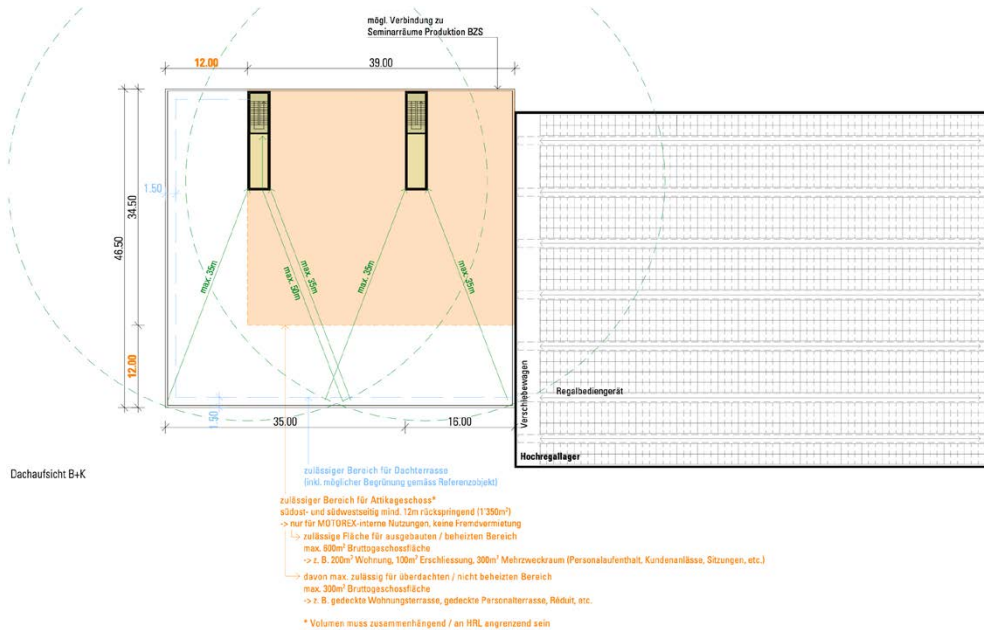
Weiterbearbeitetes Richtprojekt: Situation Dachaufsicht mit Bereich für Attikageschoss und gedeckte Terrassenbereiche (orange Fläche)
